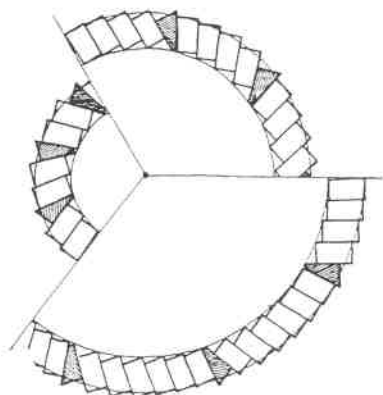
CONSTRUCCION DE CUPULAS SIN ENCOFRADO
